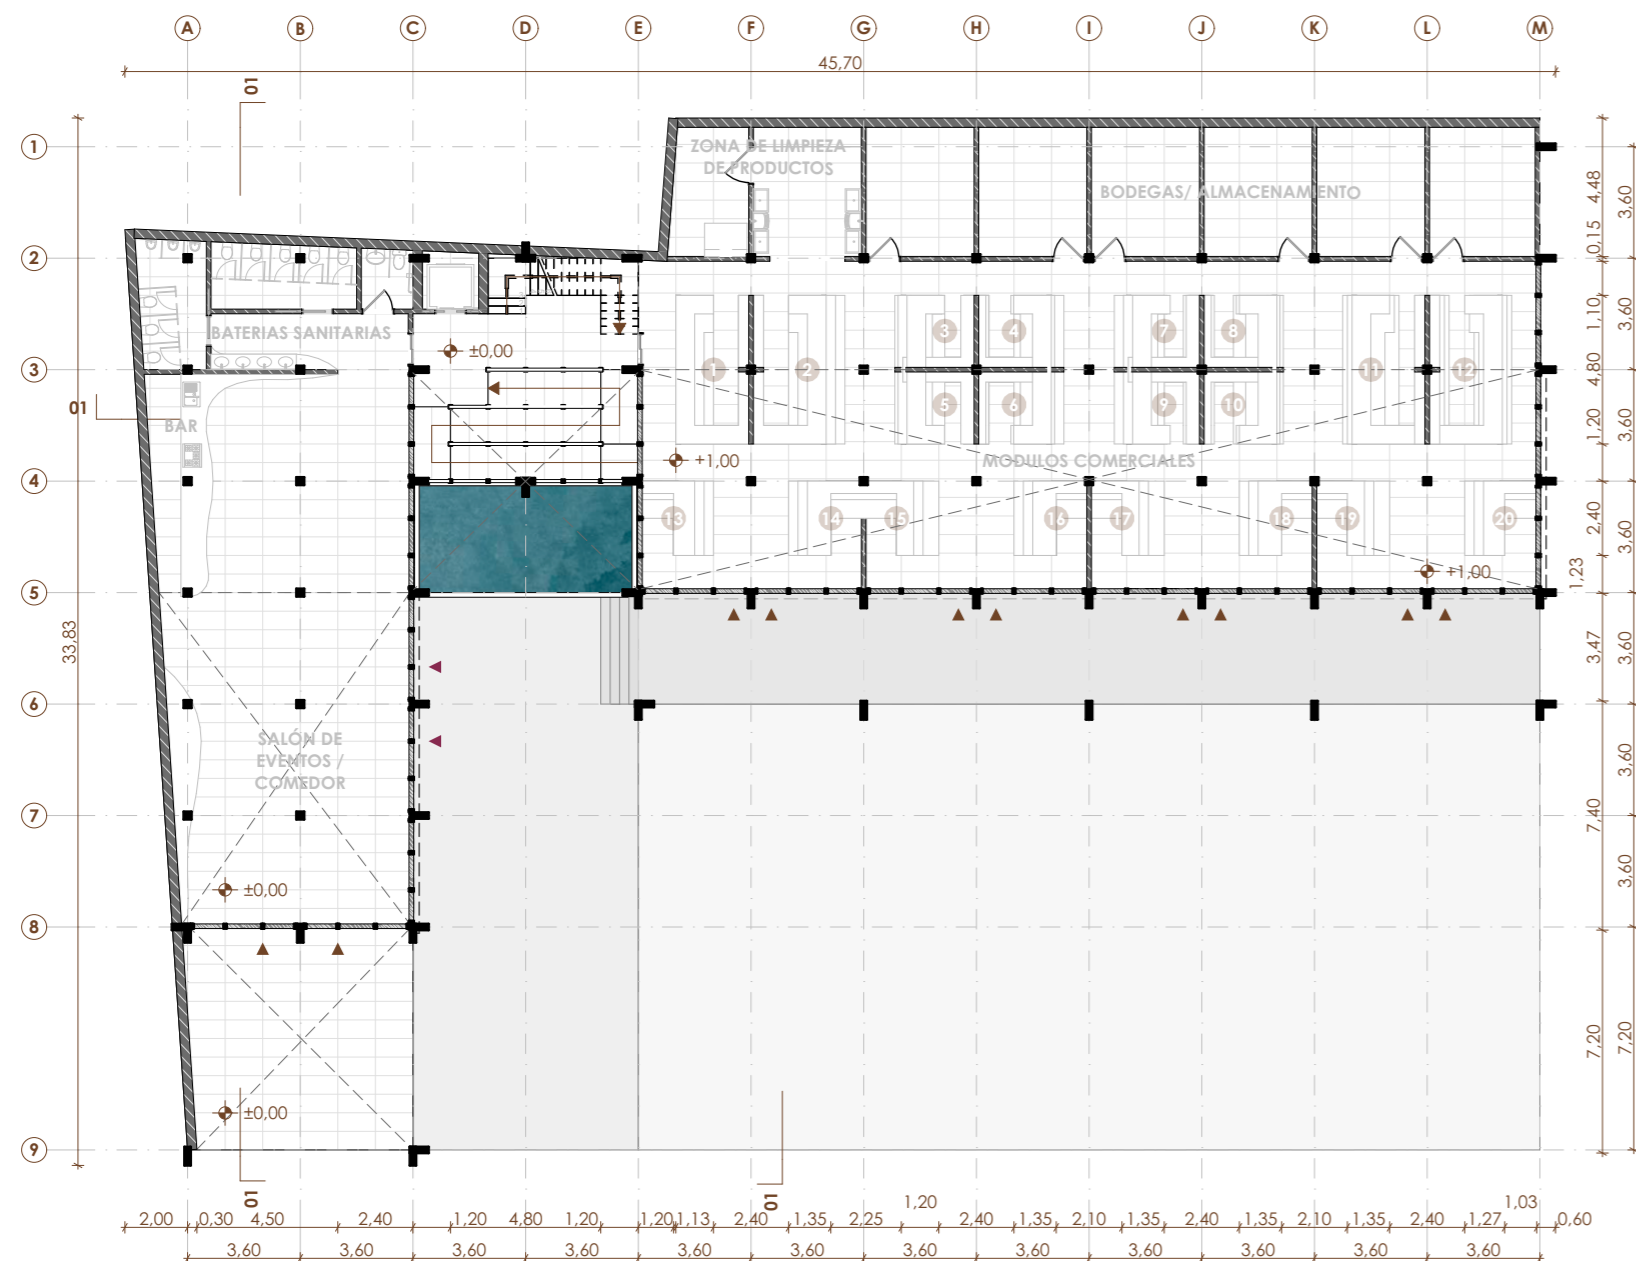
Planta baja Mercado Sacay. Fuente: Autoría propia (2026).
